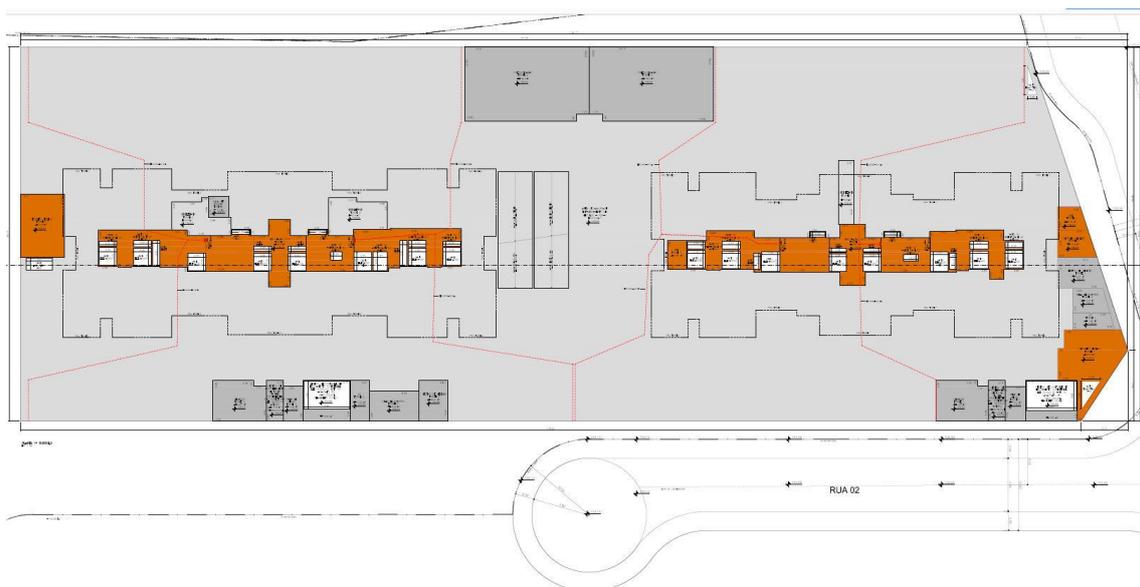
Planta do 1º Subsolo torres 1 e 2 do setor B1.
